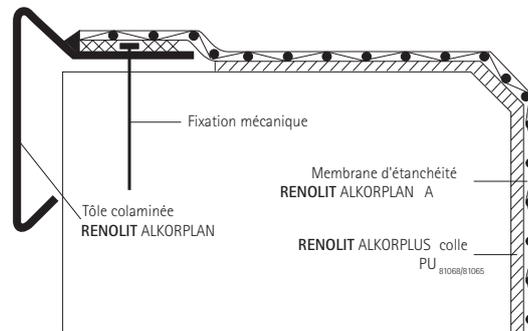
Collage en plein de la membrane RENOLIT ALKORPLAN A
